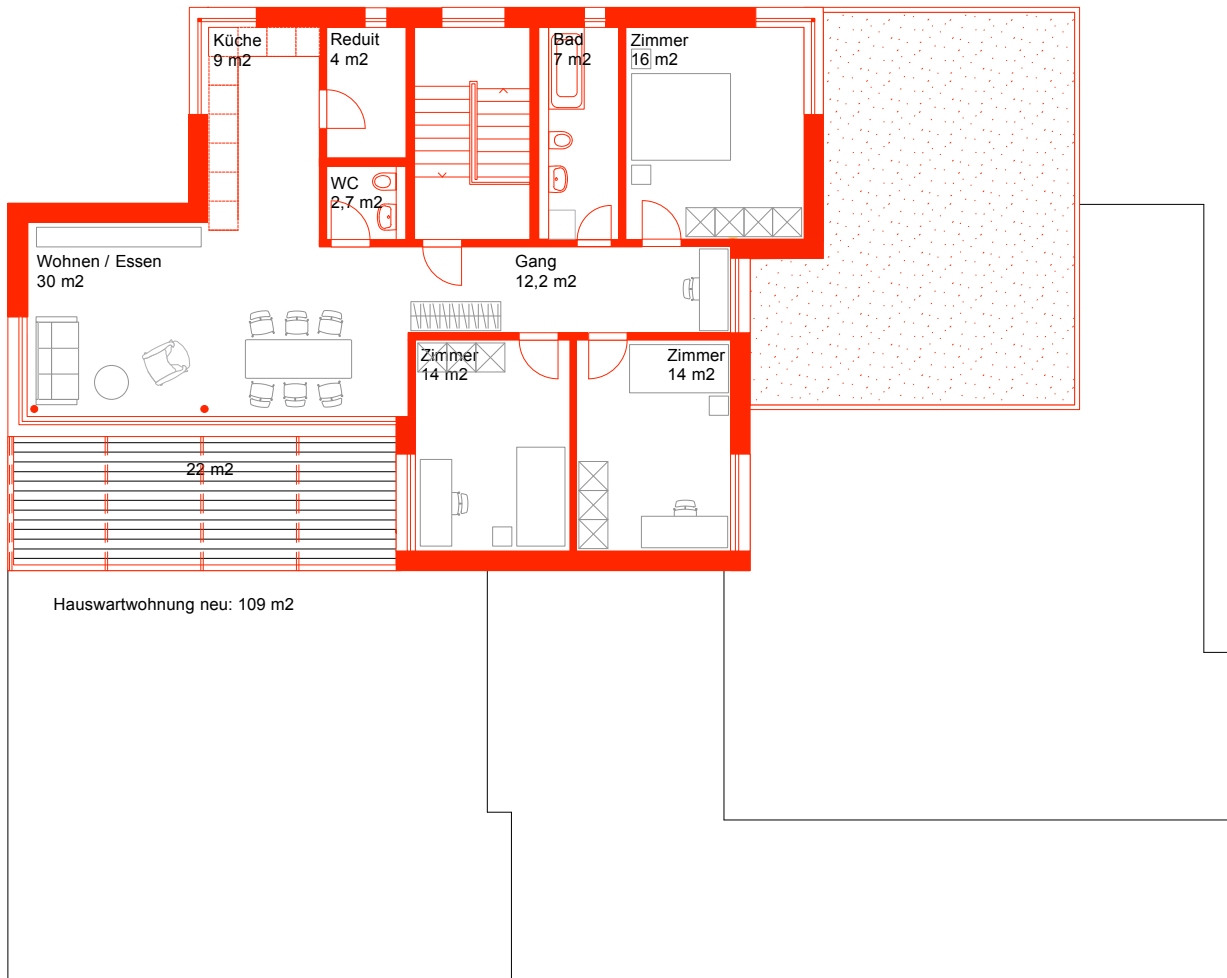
Gebäude E/2. Obergeschoss: Hauswartwohnung (Planstand Bauprojekt 2014)
